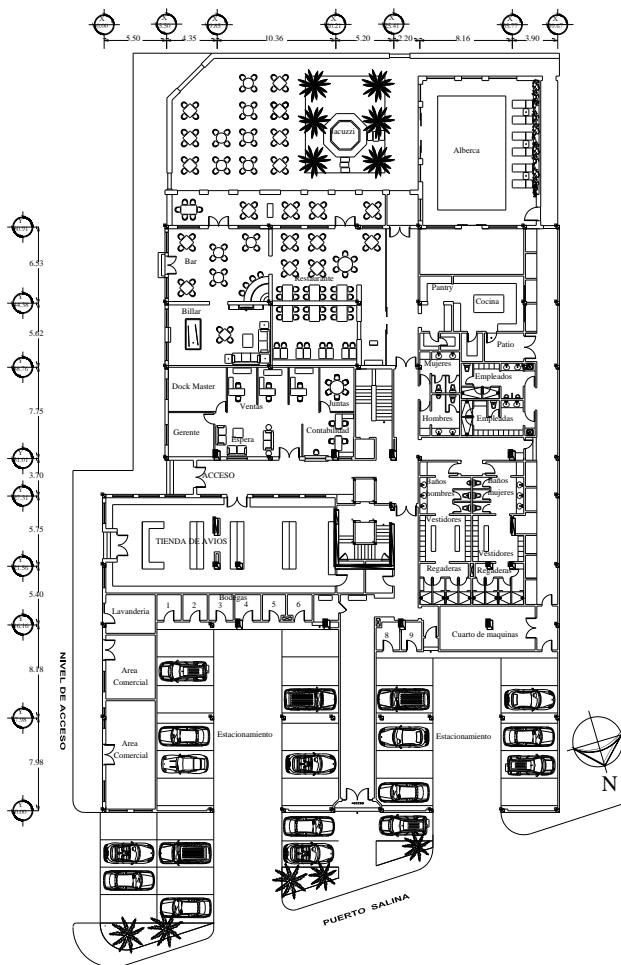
Planta Arquitectónica del 1er nivel.
